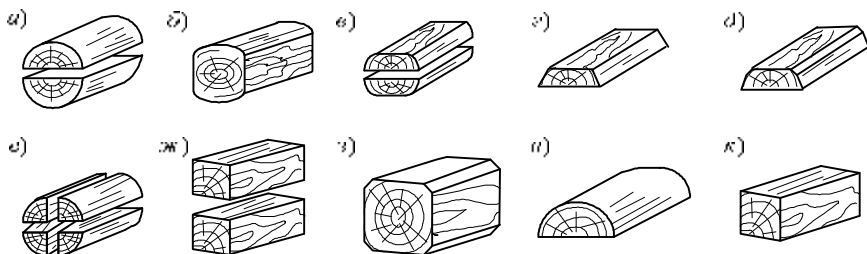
Виды пиломатериалов: а – пластины; б – двухкантный брус; в – пластины обрезные; г – необрезная доска; д – доска с тупым обзолом; е – четвертины; ж – бруски; з – брус с обзолом; и – горбыль; к – брус обрезной
